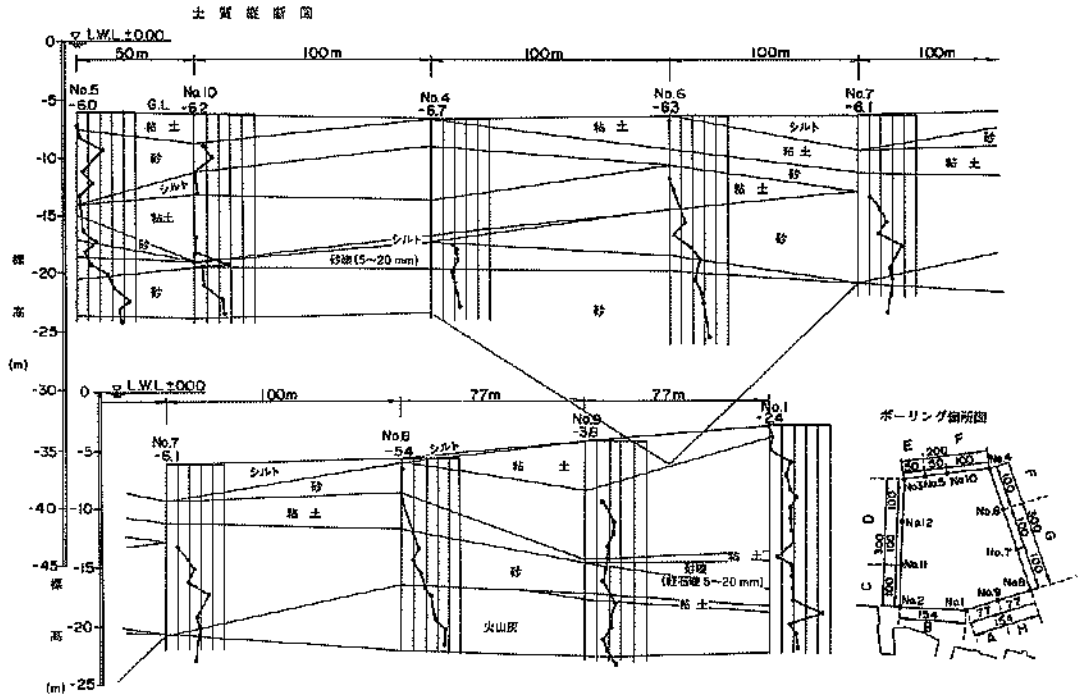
(b) 大町地区土砂処分場平面図および土質断面図
